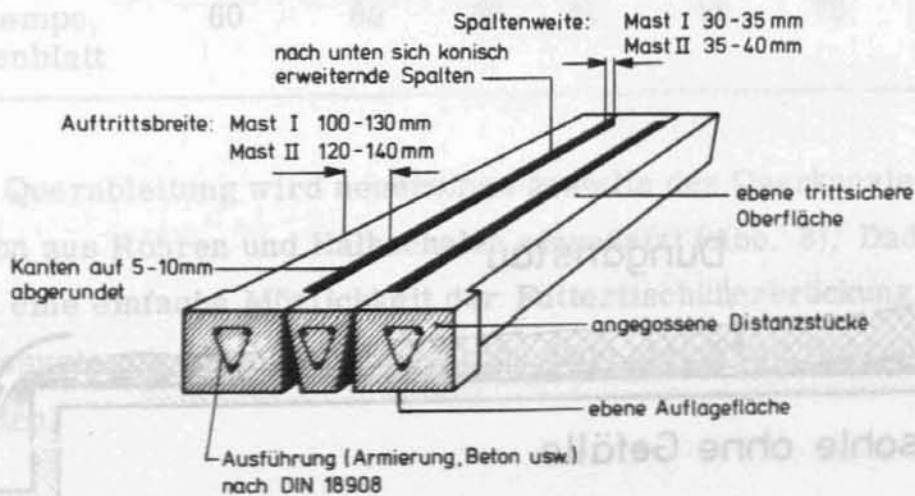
Stahlbeton - Spaltenboden für Mastbullen
